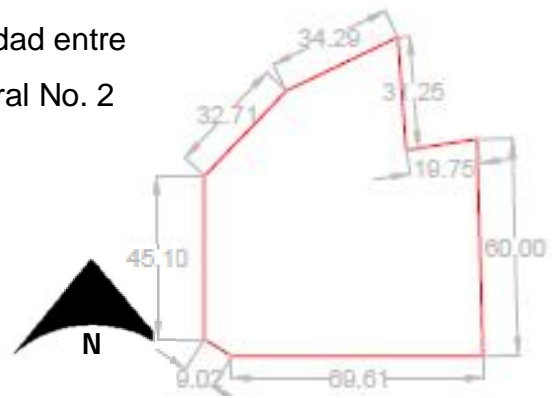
Plano de terreno 2 . Fuente Propia s/e. Cotas en m.
